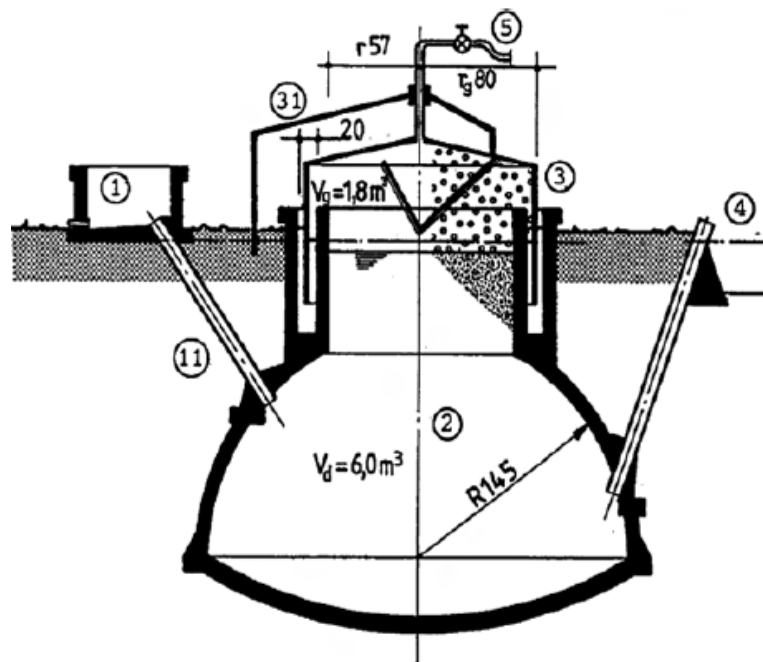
Індійський стандарт на споруду установки з плаваючим куполом
